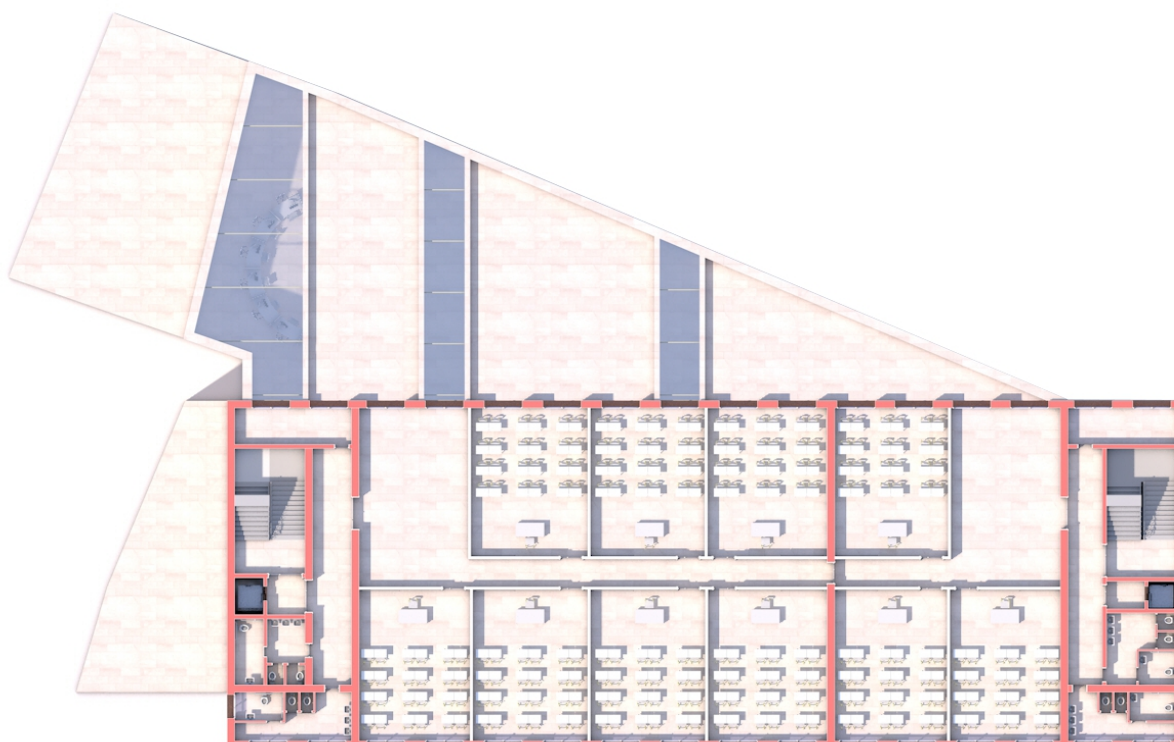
PIANTA QUARTO PIANO – CONFIGURAZIONE CON AULE TRADIZIONALI E SPAZI DI RELAZIONE
